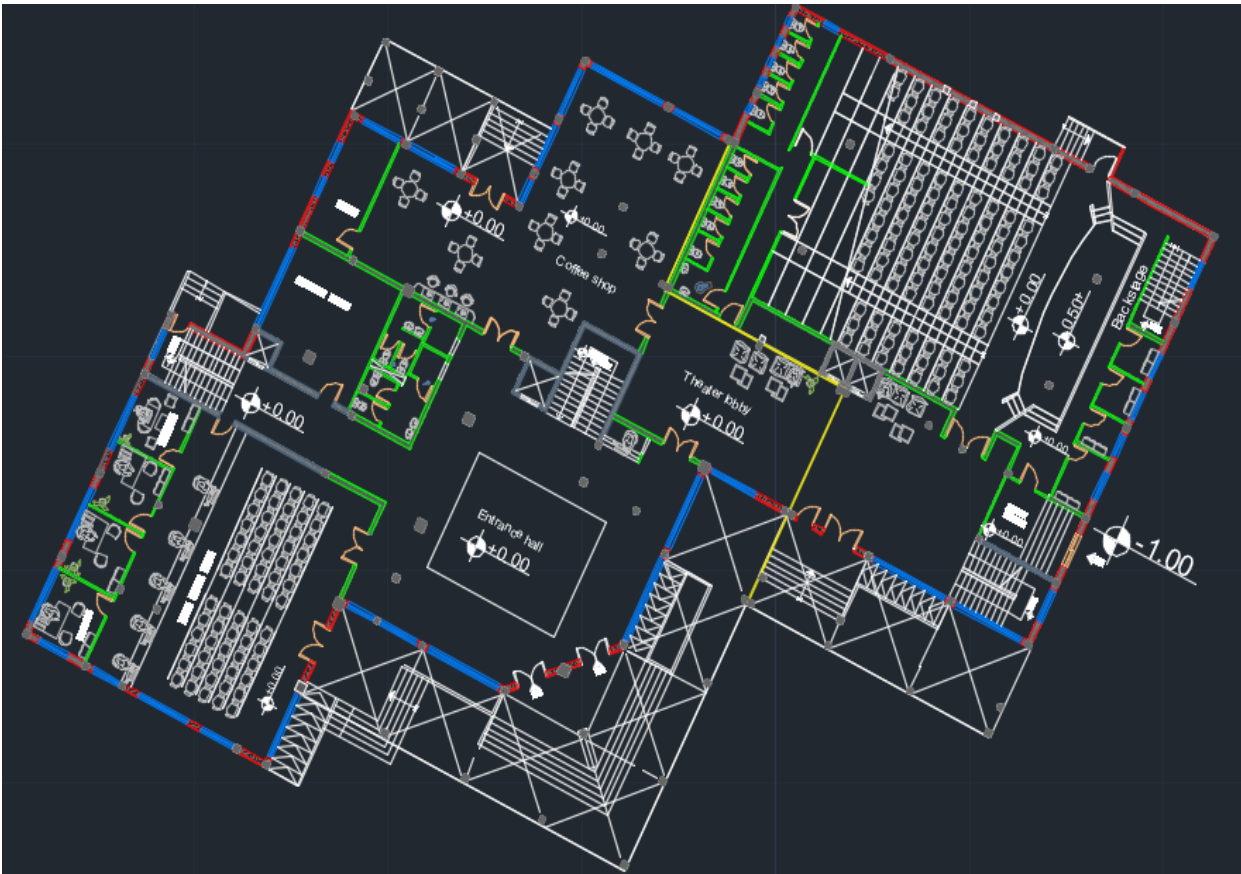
مسقط الأفقي لطابق التسوية
